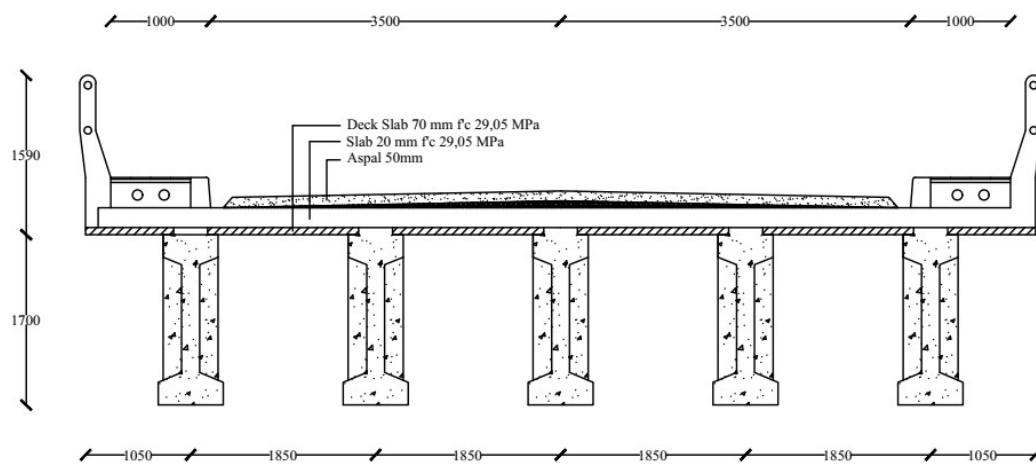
1 Sketsa Penampang Memanjang Jembatan (a) Balok Sederhana
